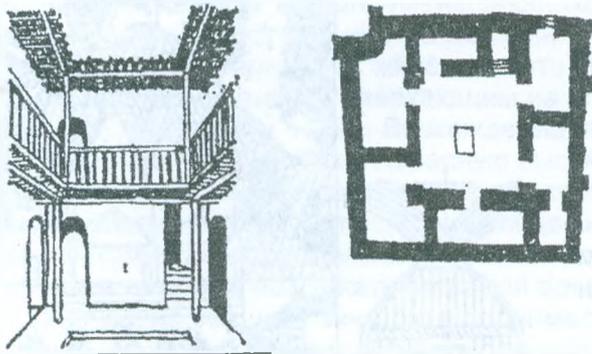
Жилой дом в Месопотамии. Внутренний дворик, план
